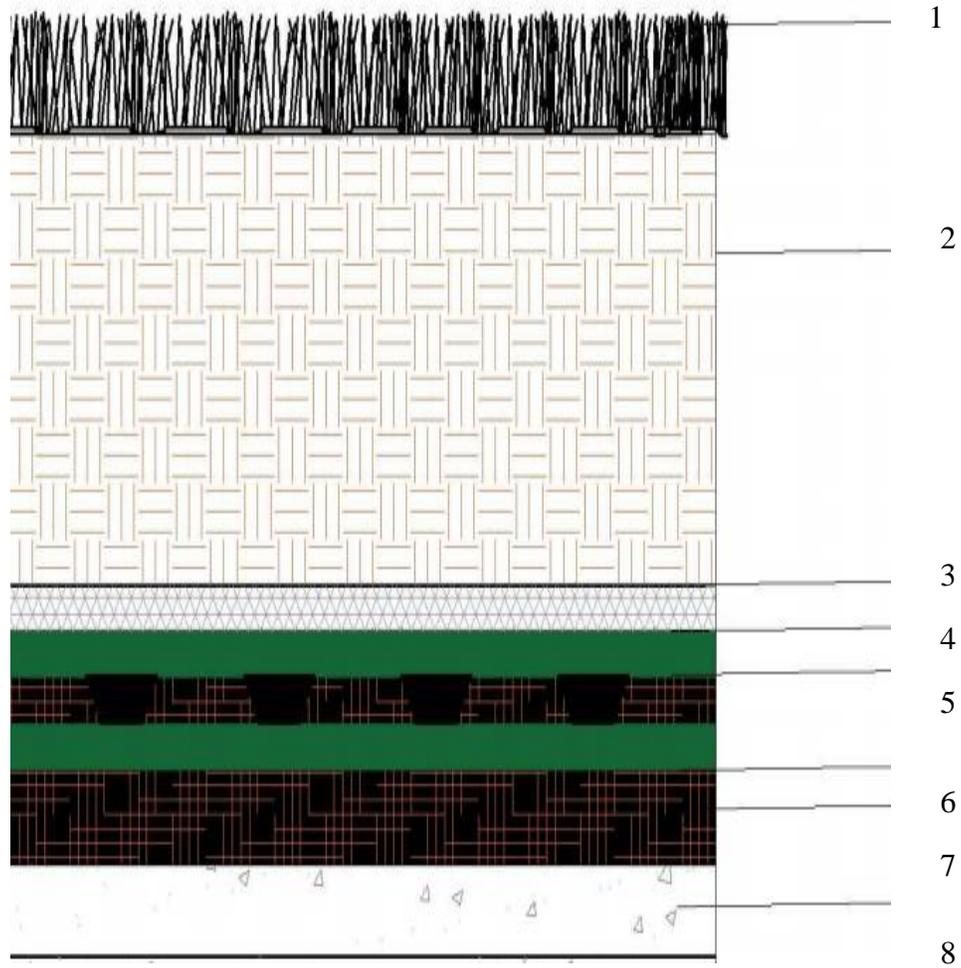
Corte del sistema propuesto expone corte cubierta verde sistema propuesto, elaboración propia
